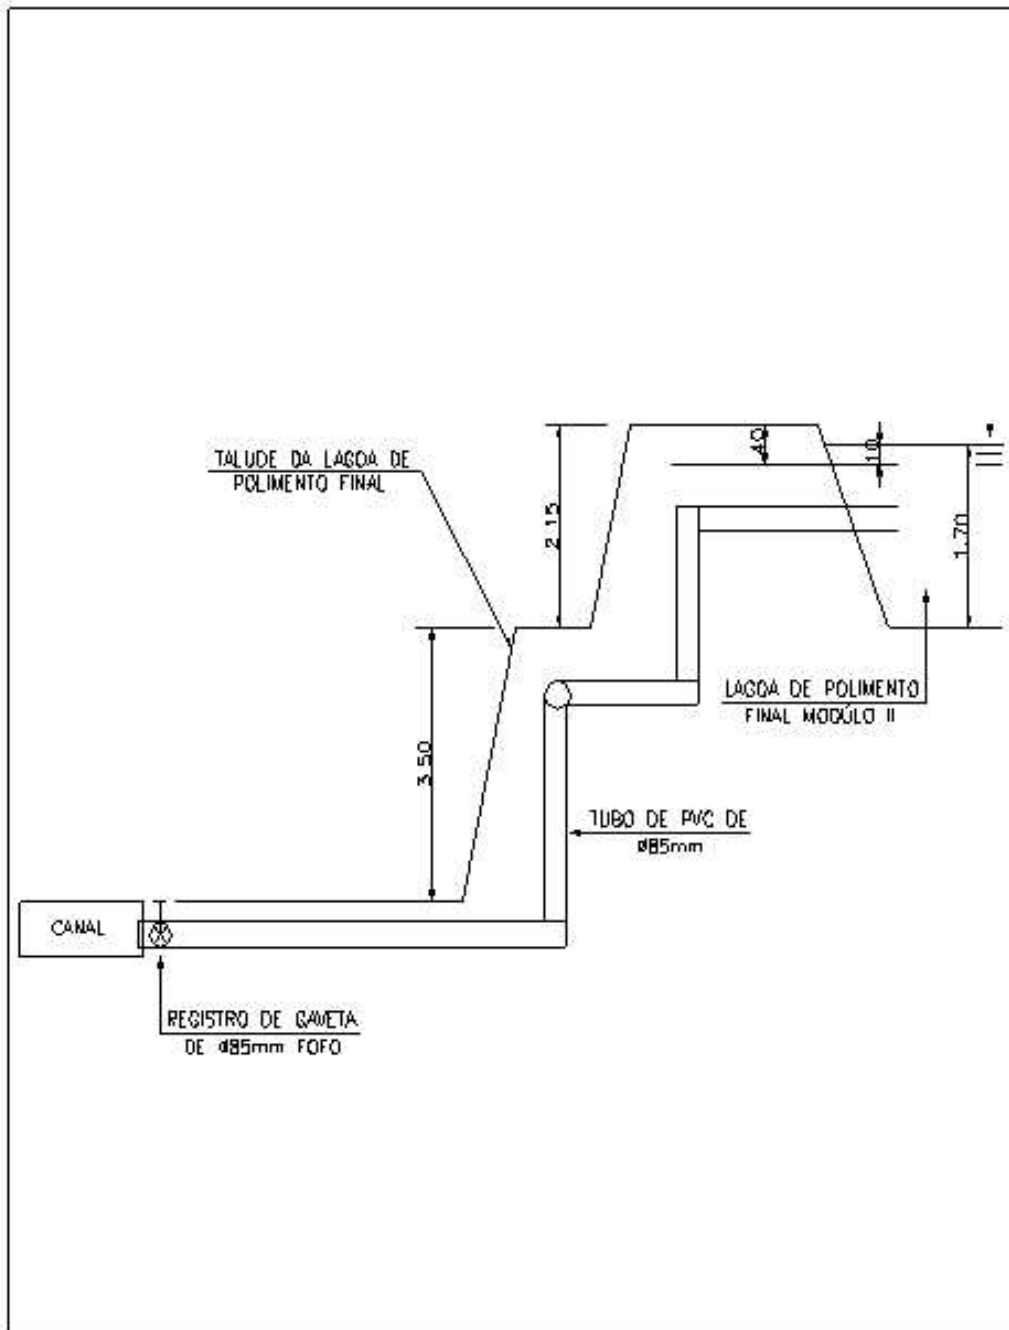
Croquis da instalação hidráulica dos tanques da ETE Samambaia (Vista lateral em corte)
